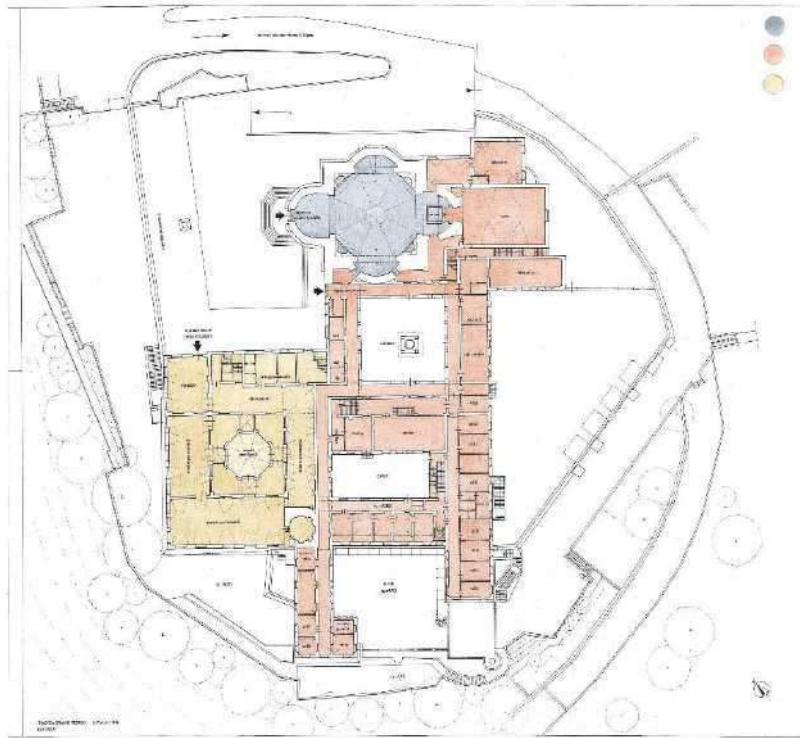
Pianta piano terreno (piazzale); in rosso i locali del convento
